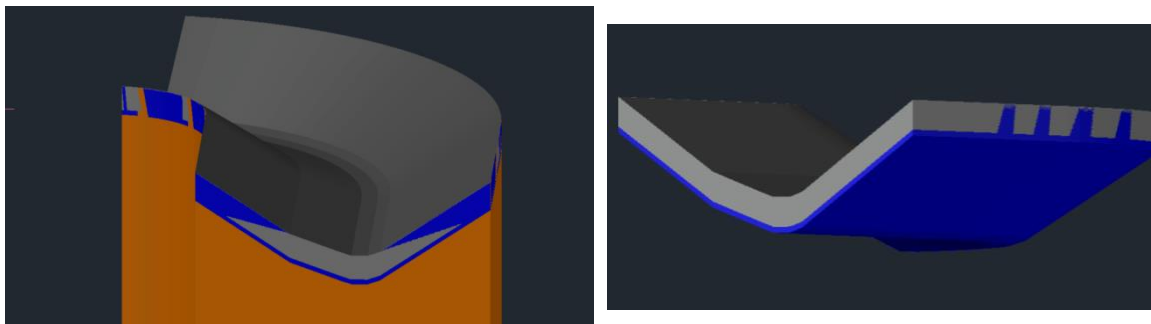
Sección de los márgenes del río propuesta para mejorar el cálculo geotécnico.
